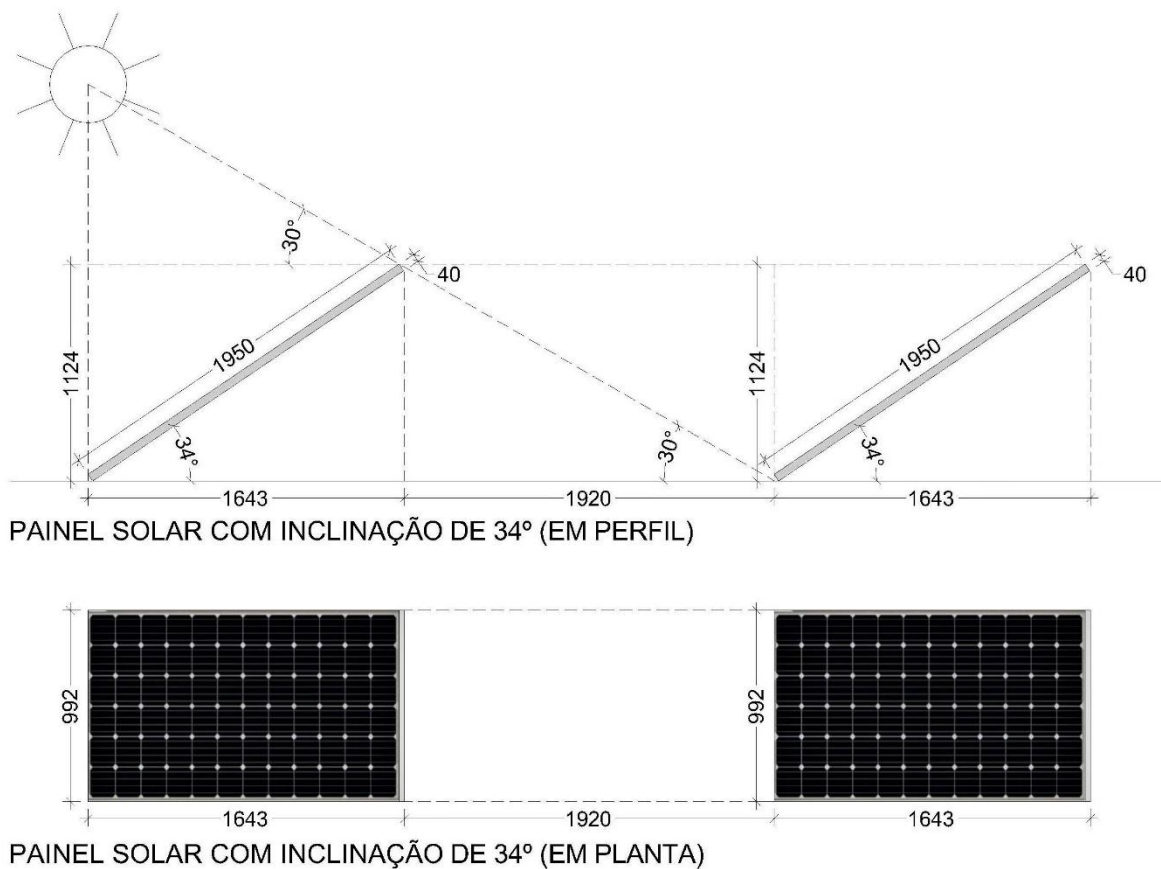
Dimensões de ocupação da área disponível, em planta e perfil (1995 x 1002 x 40mm).
